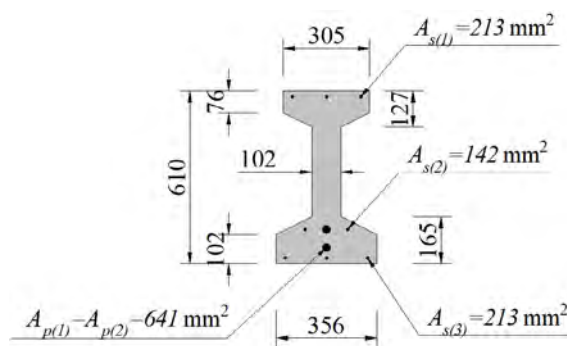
Sección de las vigas ensayadas por Breckenridge y Bugg [14].
